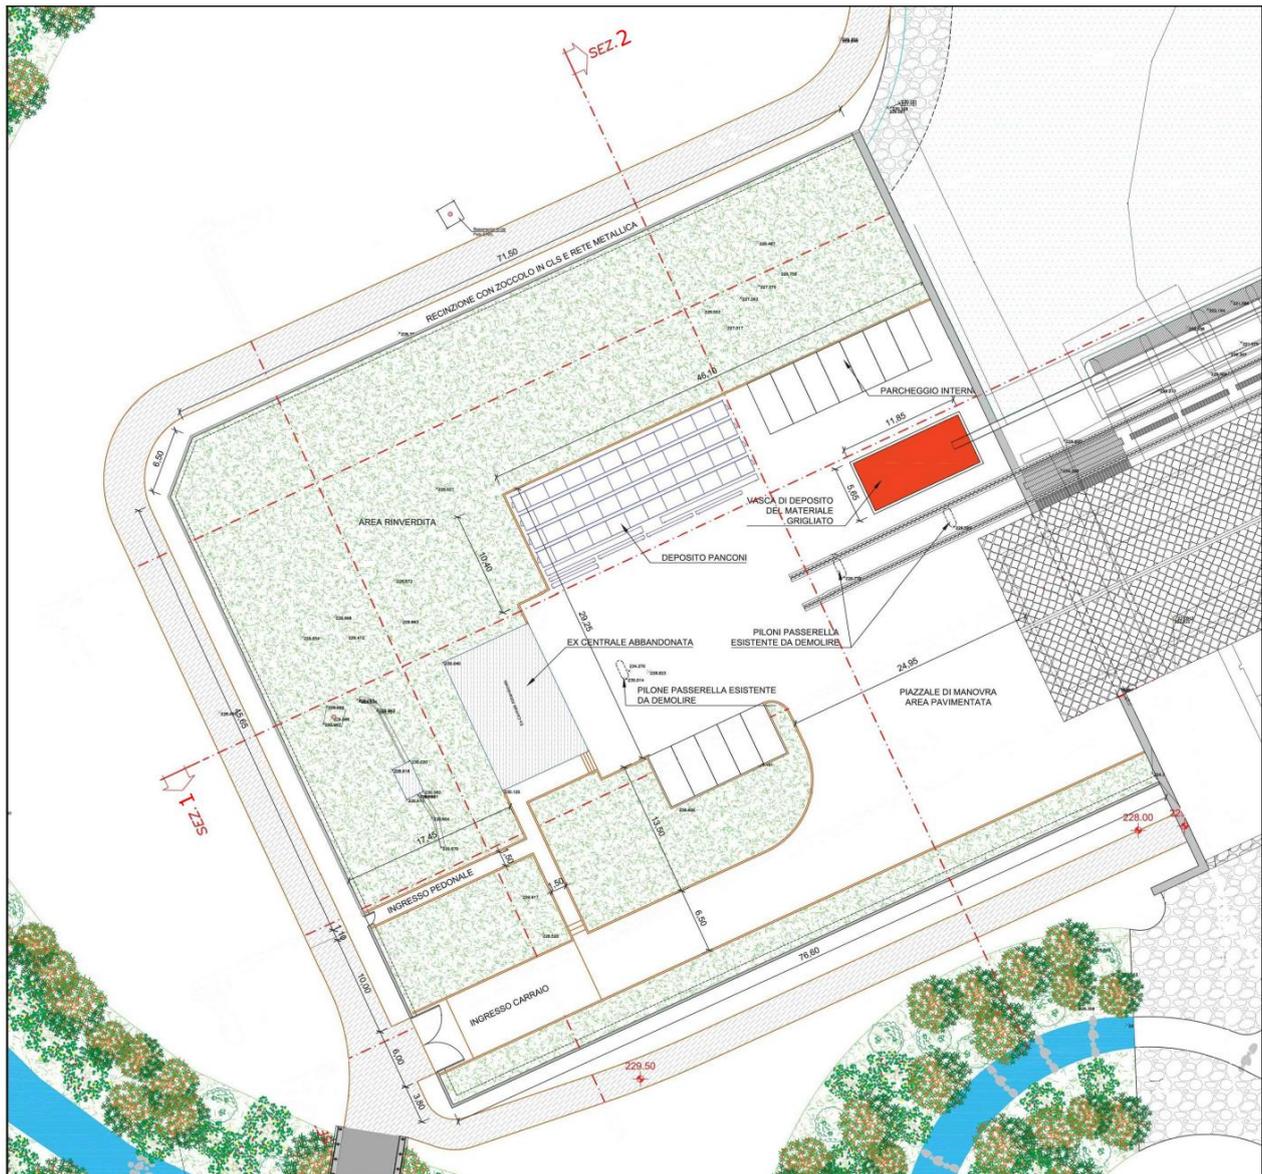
PIAZZALE DI SERVIZIO DELLA CENTRALE IDROELETTRICA IN RILEVATO A QUOTA 230.70 M S.L.M. PERIMETRATO MEDIANTE CORDOLO IN CALCESTRUZZO A PROTEZIONE DELLO SCALZAMENTO DEL RILEVATO
